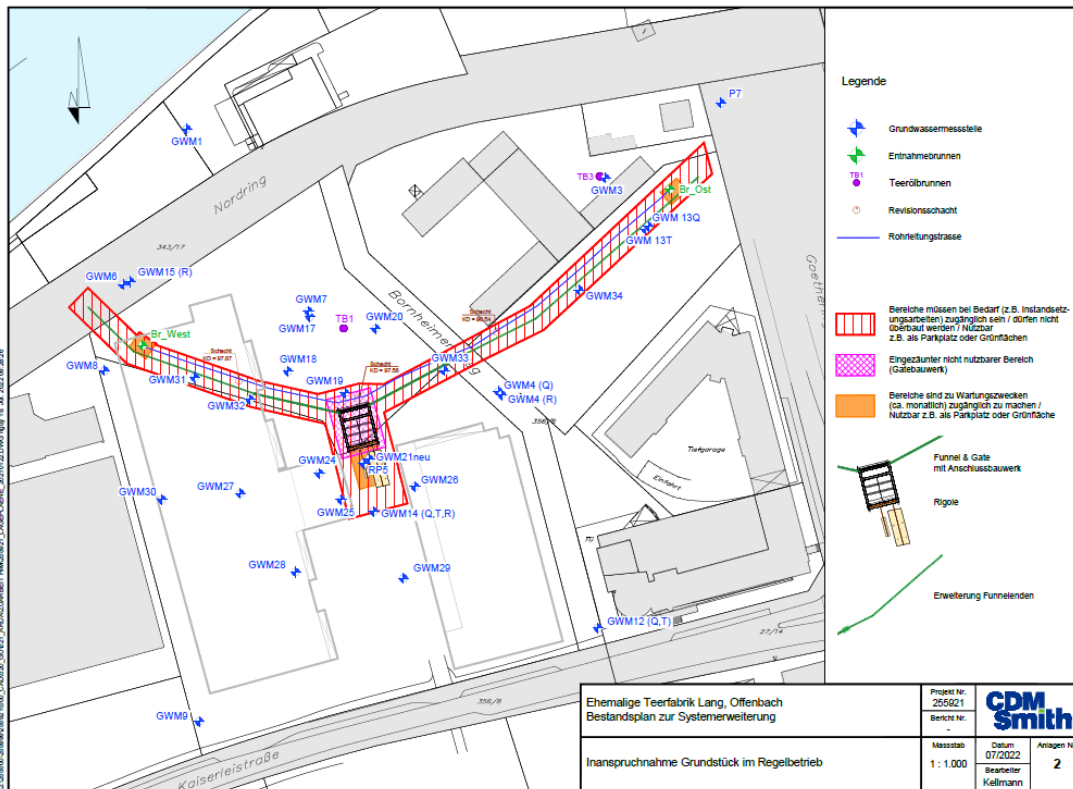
Bestandsplan der Funnel & Gate-Anlage, Planstand: 07.2022, CDM Smith, unmaßstäblich
